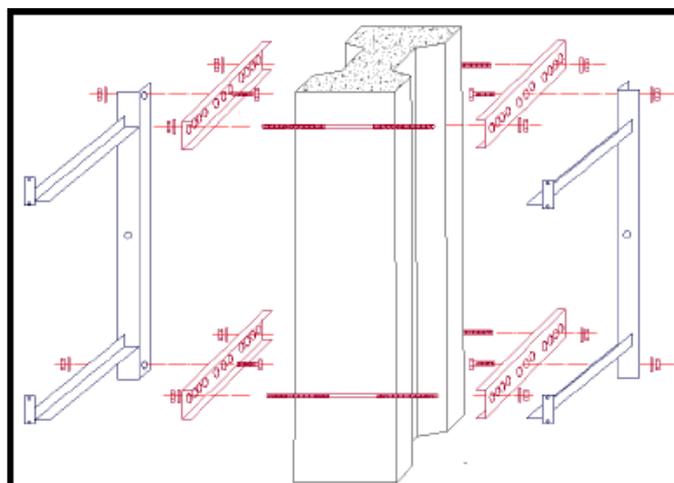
Adaptador da Ferragem de fixação para aplicação em zonas sem furação dos apoios de betão
